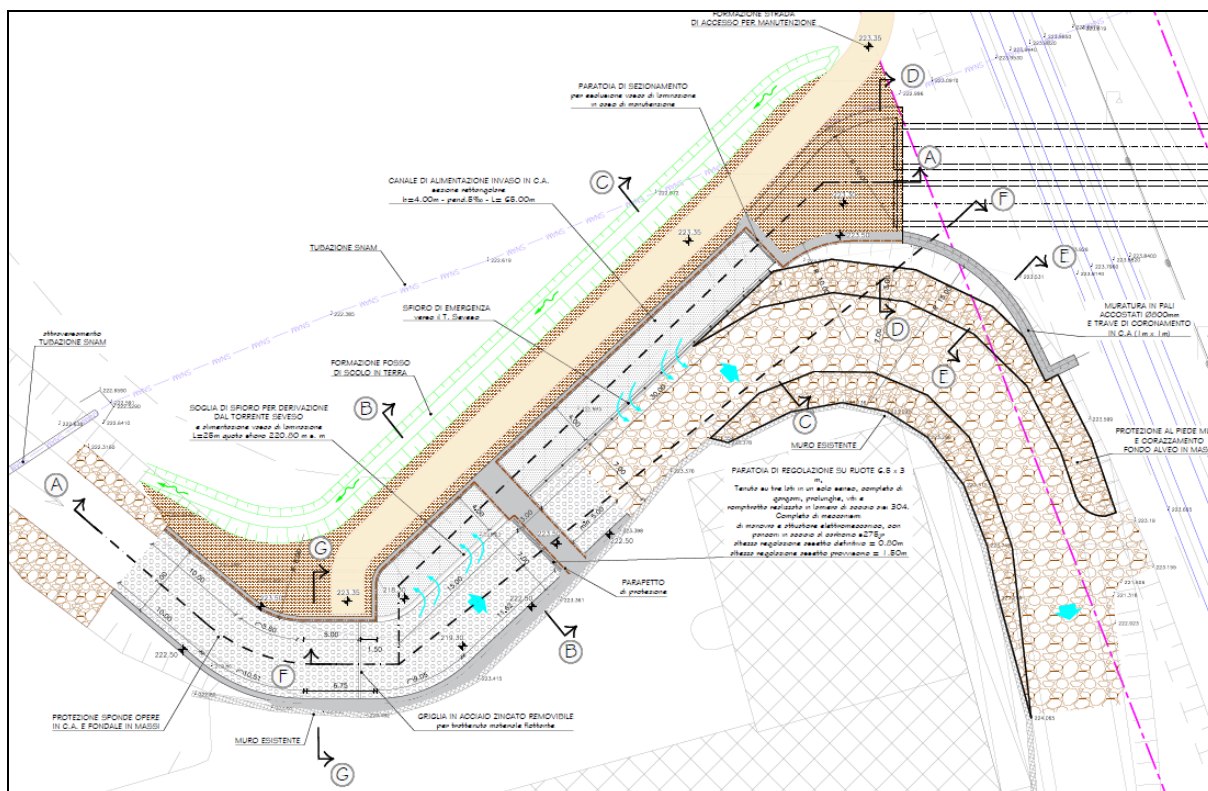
Planimetria di progetto dell'opera di presa dal T. Seveso
